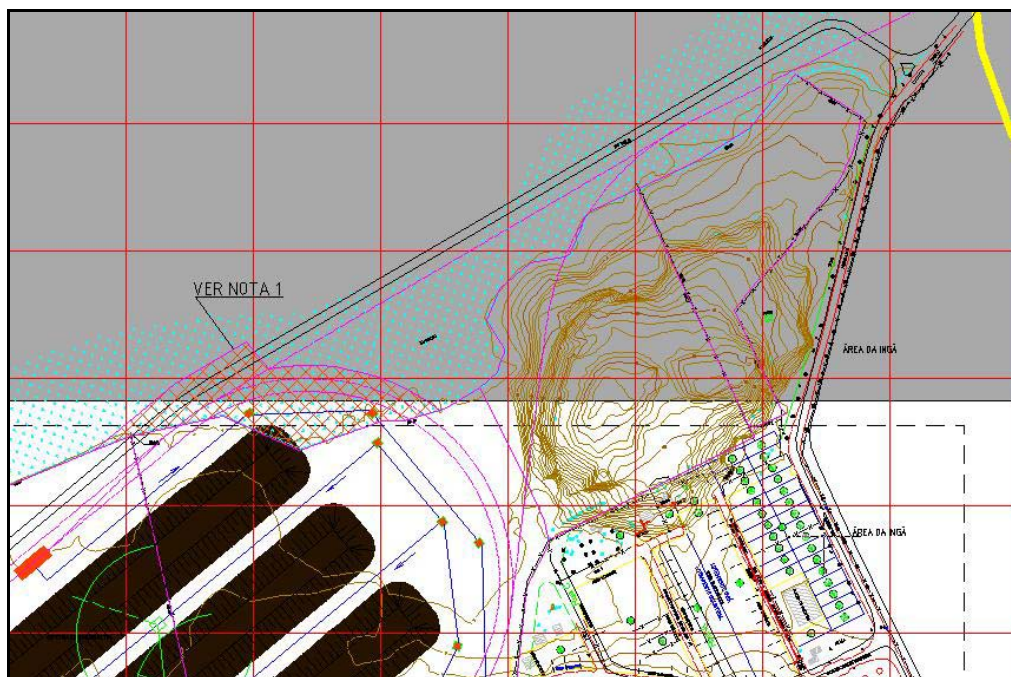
Alternativa 1 para a locação da perra ferroviária
